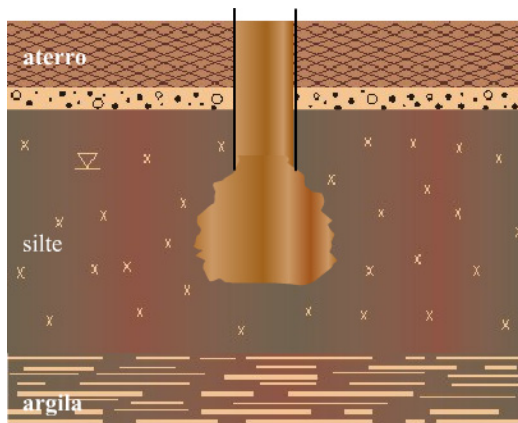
Colapso da parede da escavação abaixo do revestimento da estaca
